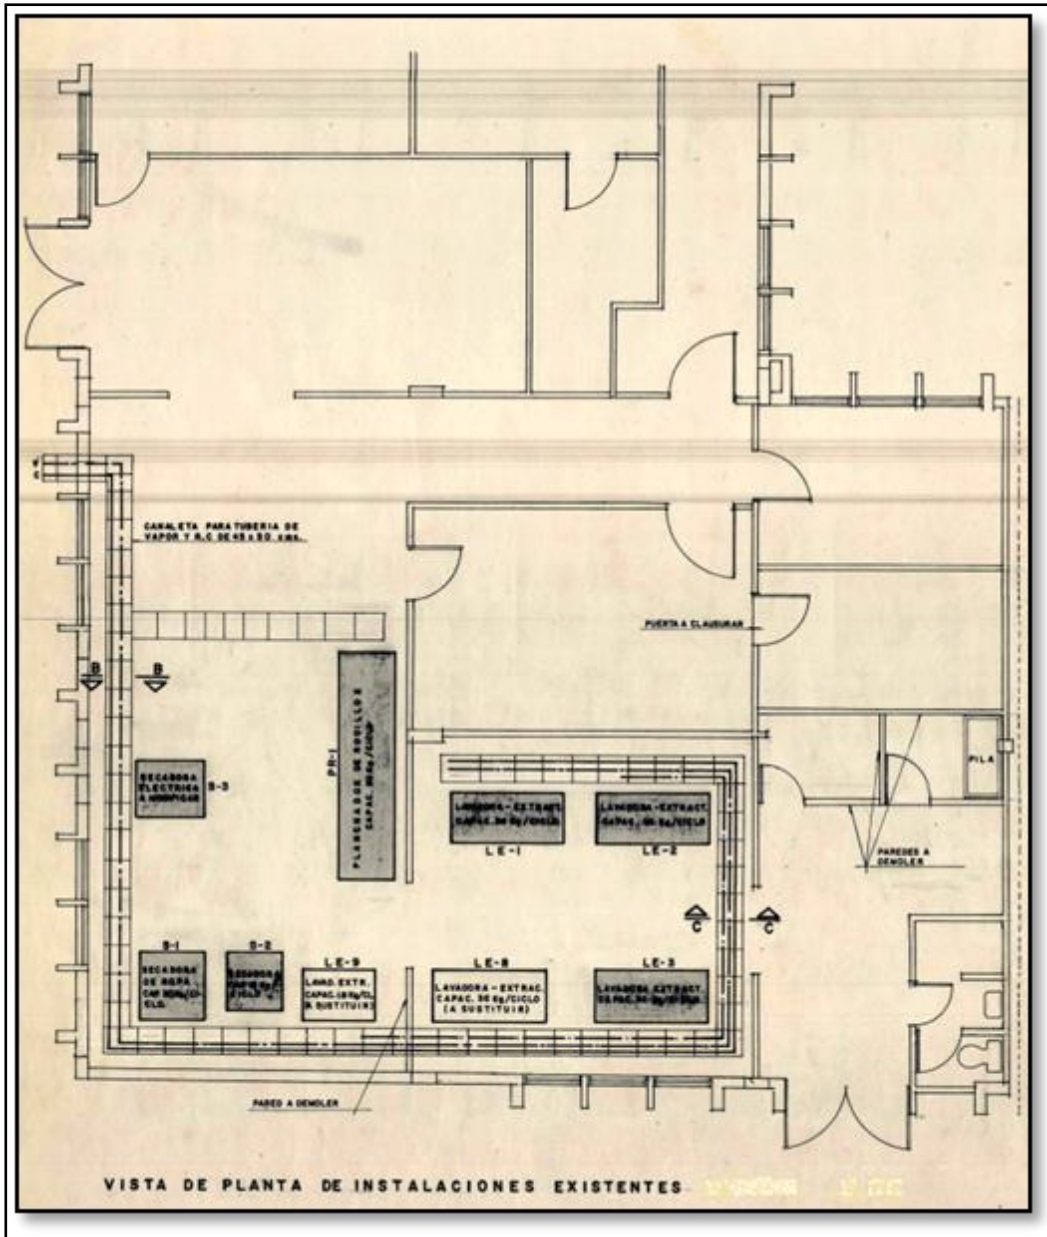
Vista de planta de instalaciones existentes en el área de lavandería.
